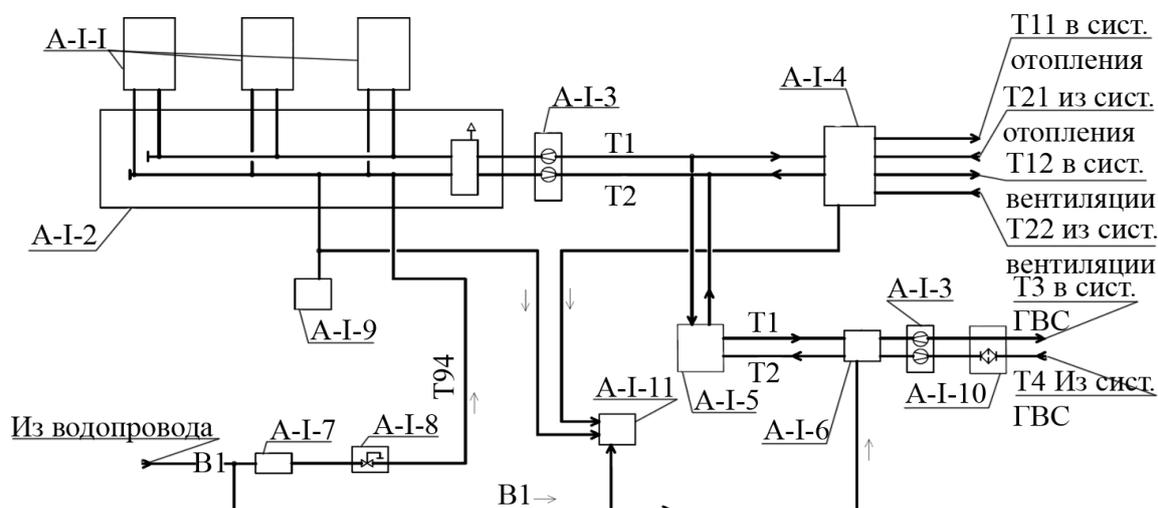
Тепловая схема котельной: T1 – подающий трубопровод тепловой сети; T2 – обратный трубопровод тепловой сети
